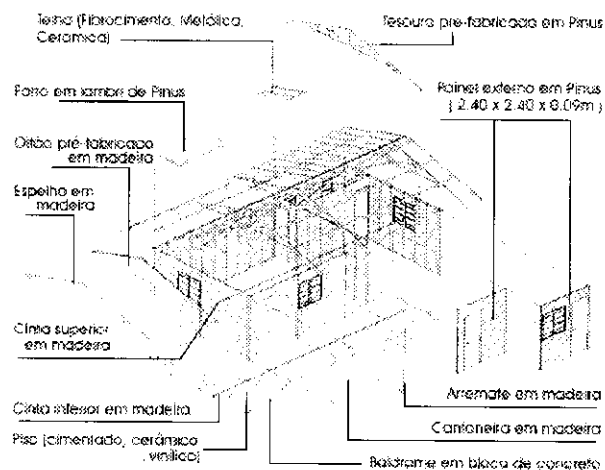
Esquema de montagem da alternativa pré-fabricada de madeira
